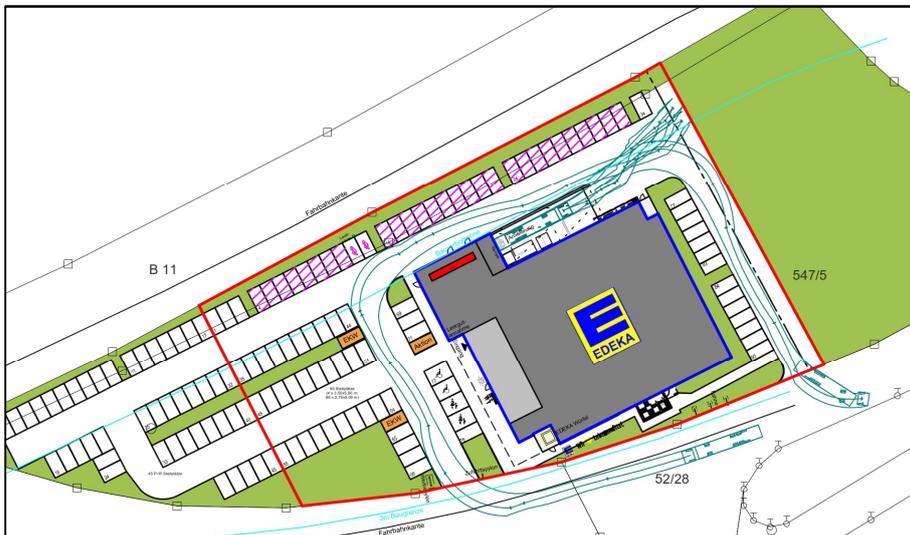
Lageplan mit Darstellung eines möglichen Lebensmittelmarktes im Planungsbiet / 23/
